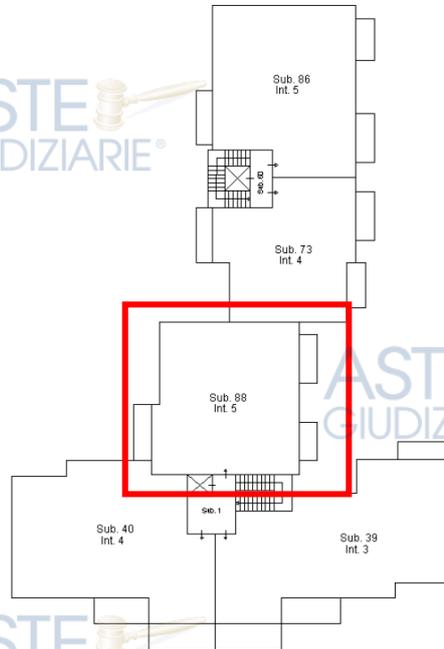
Estratto dell'Elaborato Planimetrico, dal quale dedurre i confini del subalerno 88 (appartamento)
